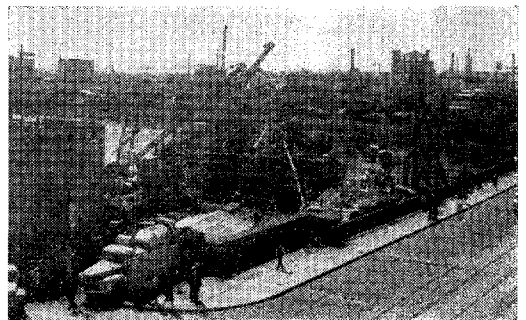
No. 5 ケーソン・コンクリート打ちの作業現場
